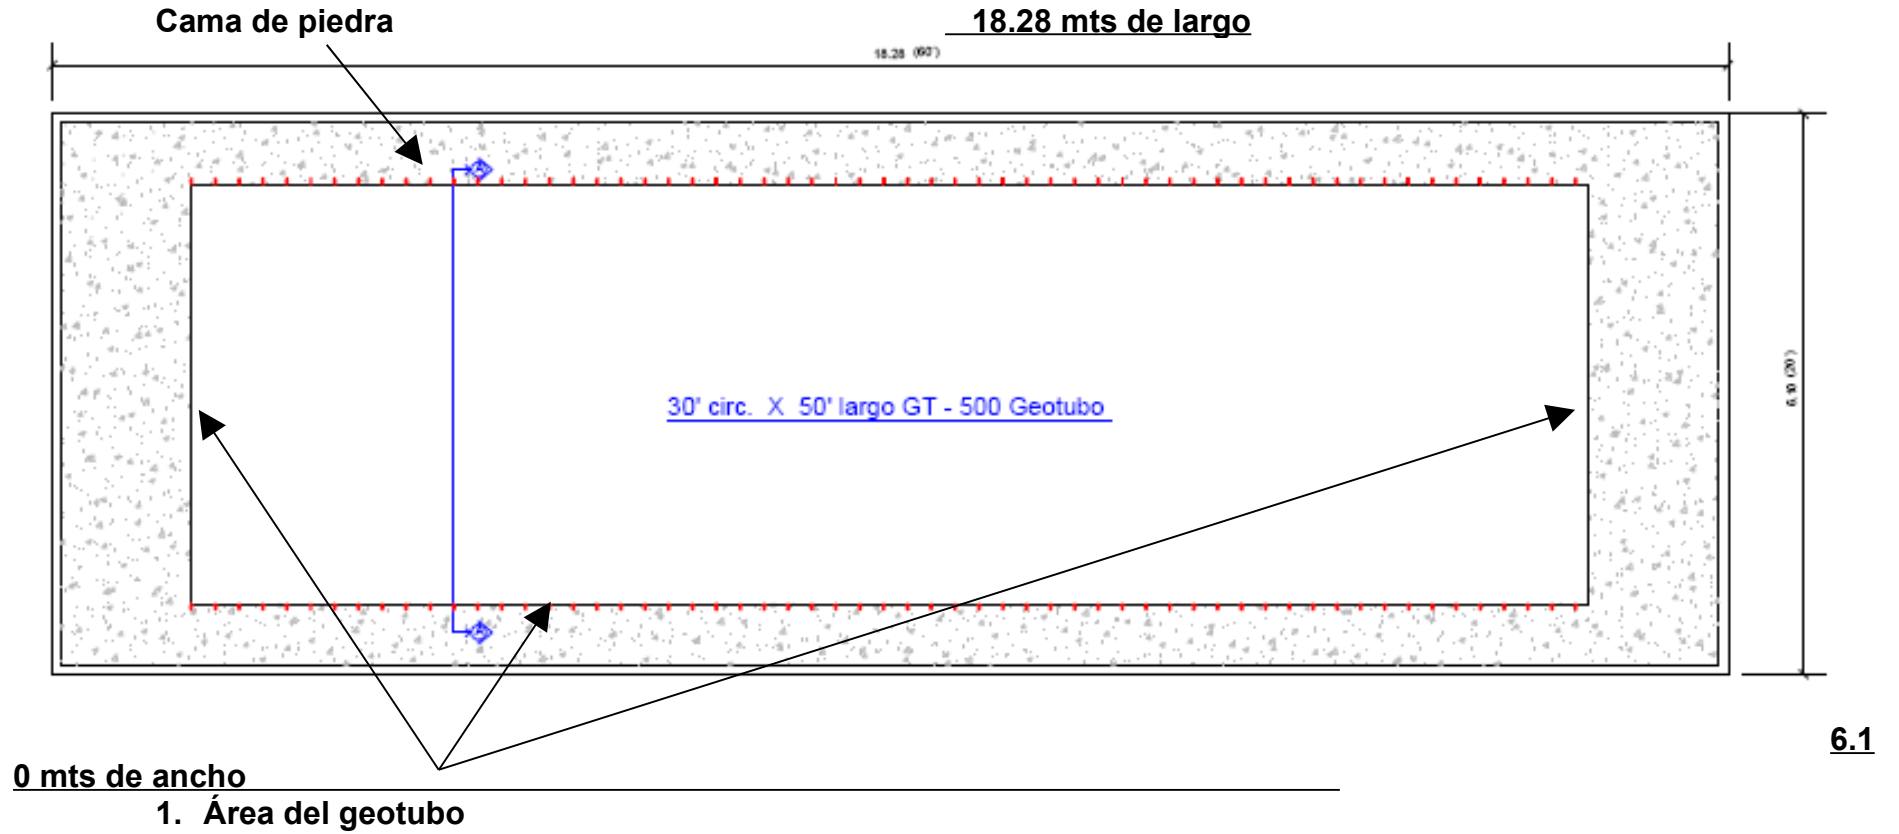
VISTA HORIZONTAL DEL GEOTUBO.
